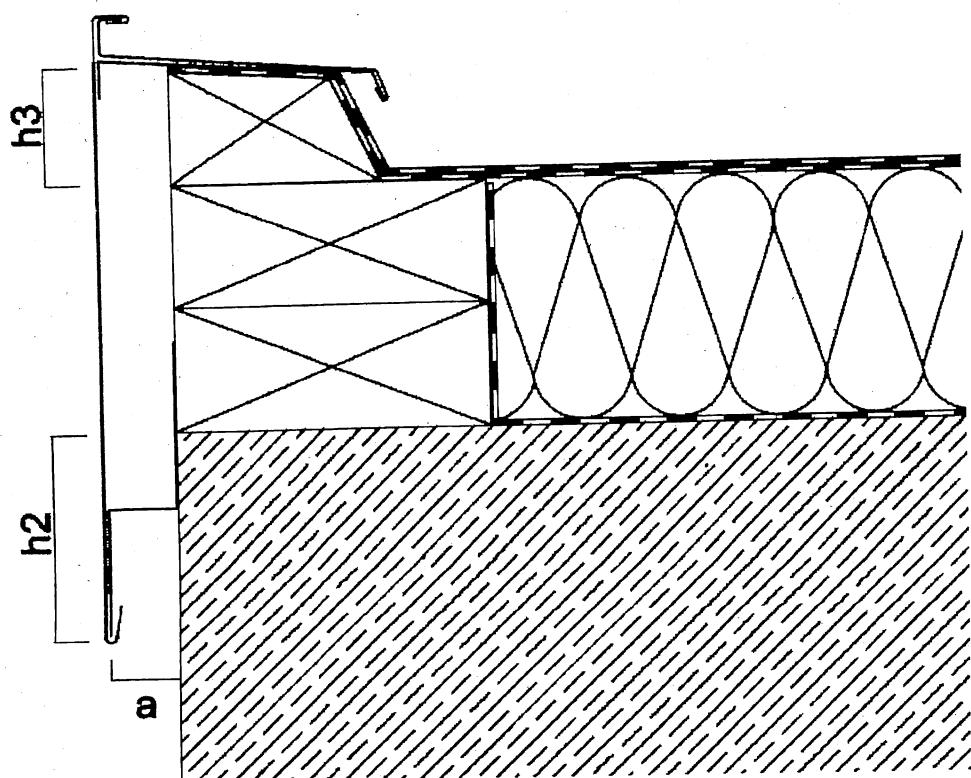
Ortgang Flachdach mit hochgeführter Dachabdichtung und Metallabdeckung
